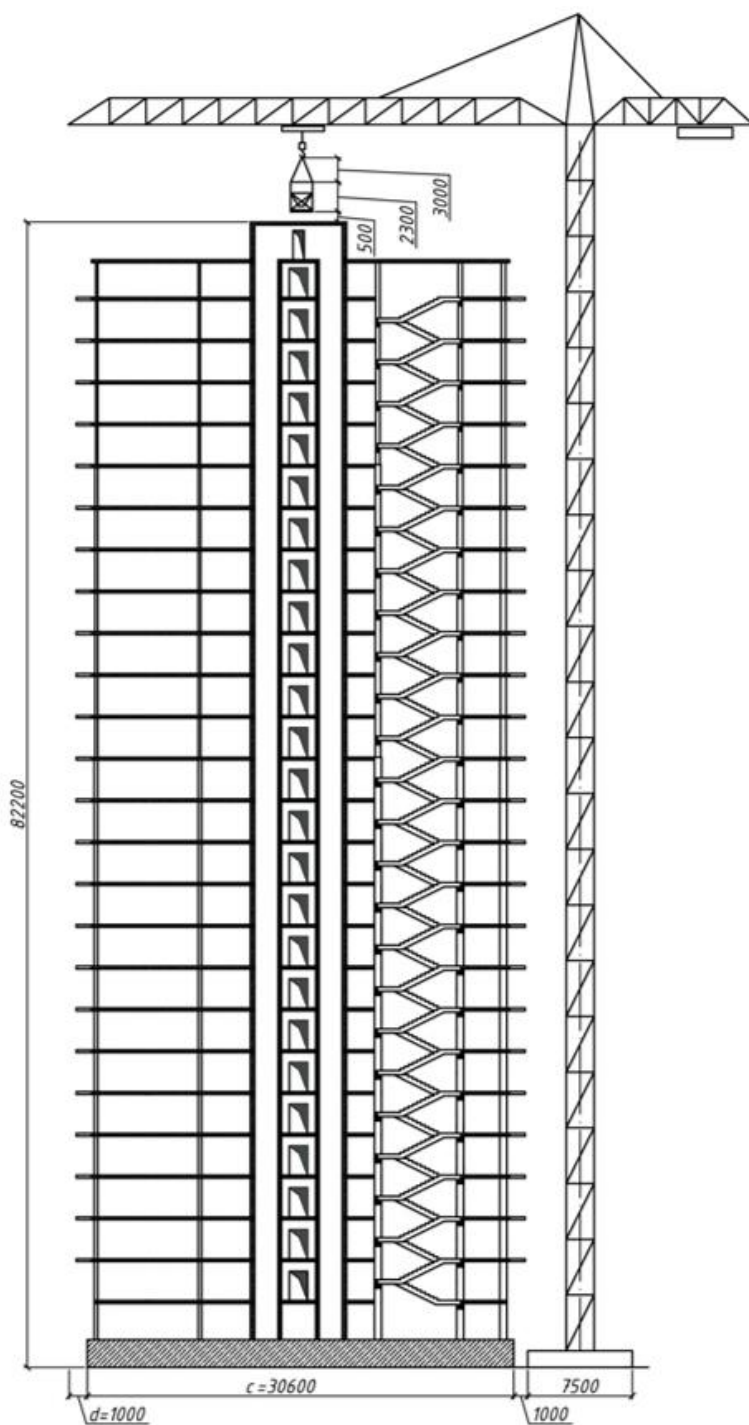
Графічна схема до вибору монтажного крану
